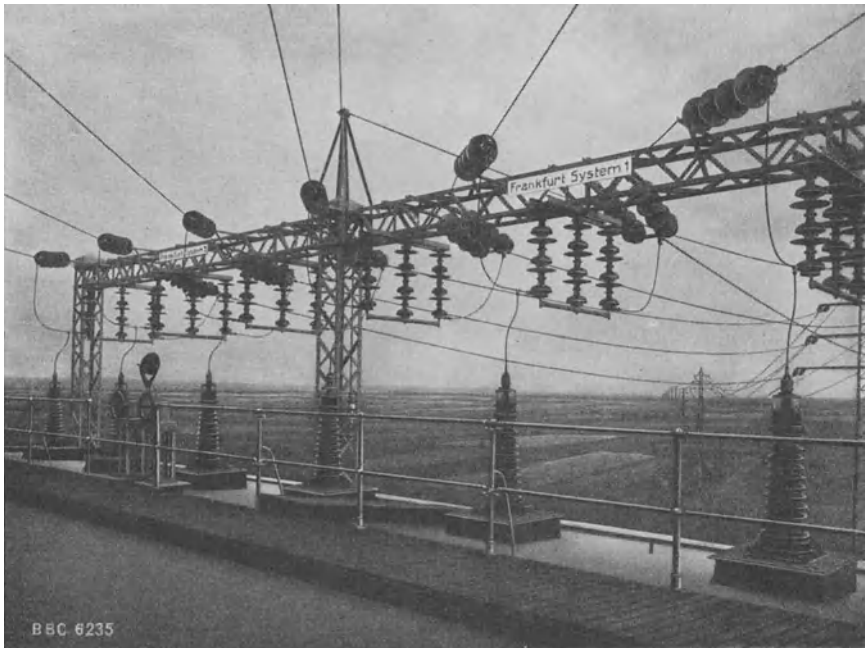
Freileitungs-Trennschaltergerüst auf dem Dach und Dachführungen, 100 kV. BBC.
